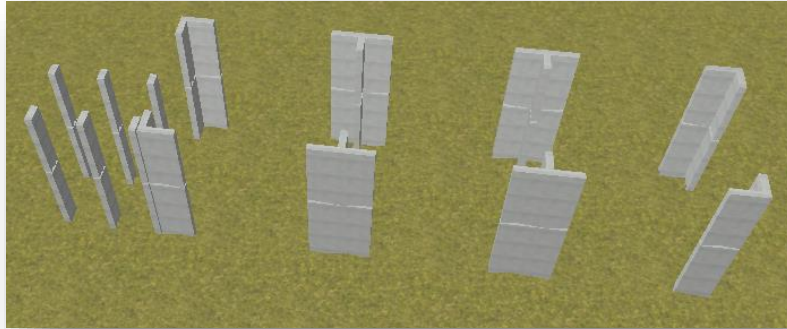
Vista extruida de las columnas en "L", "T" y rectangulares.
